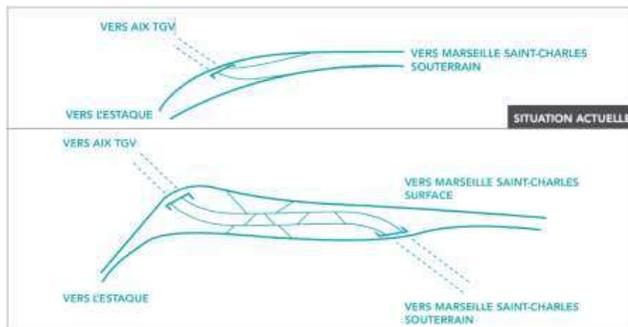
Schéma du raccordement d'entrée en tunnel au droit de la Delorme (Dossier de concertation 2021)
